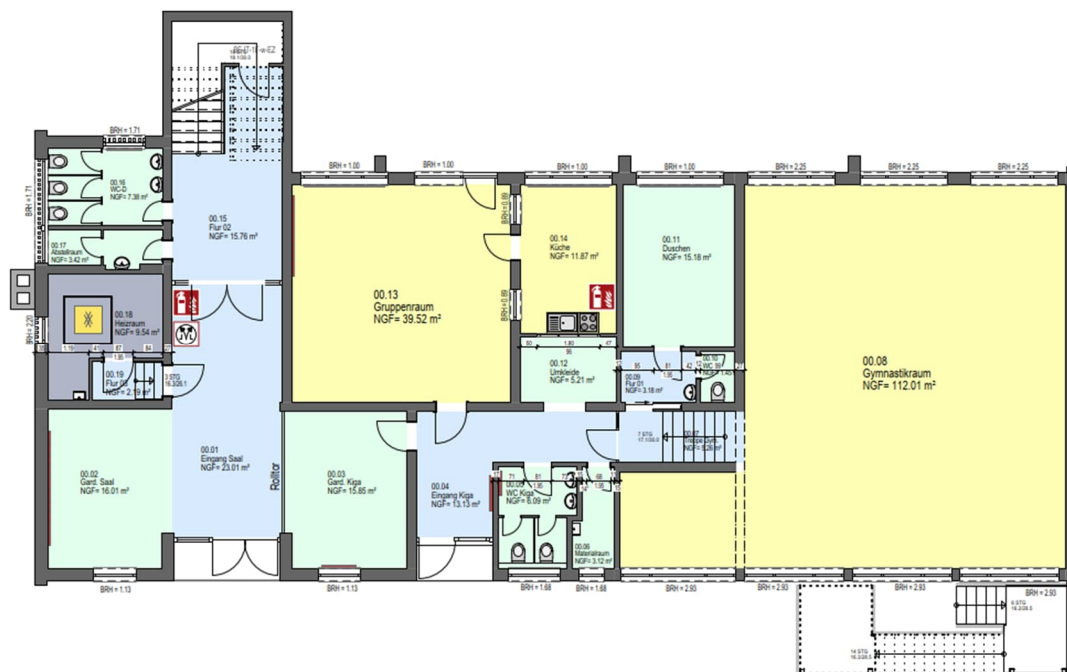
Übersicht Grundriss Erdgeschoss Bestand
